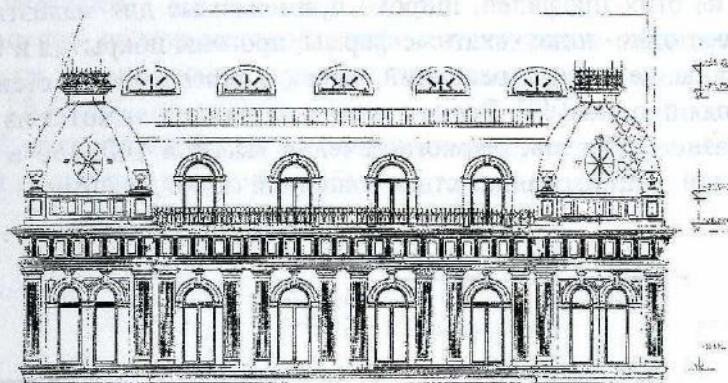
Фасад здания по ул. Крещатик в Печерском районе г. Киева
